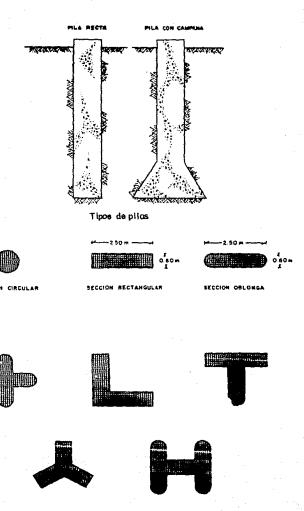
TIPOS Y SECCIONES DE PILAS.
